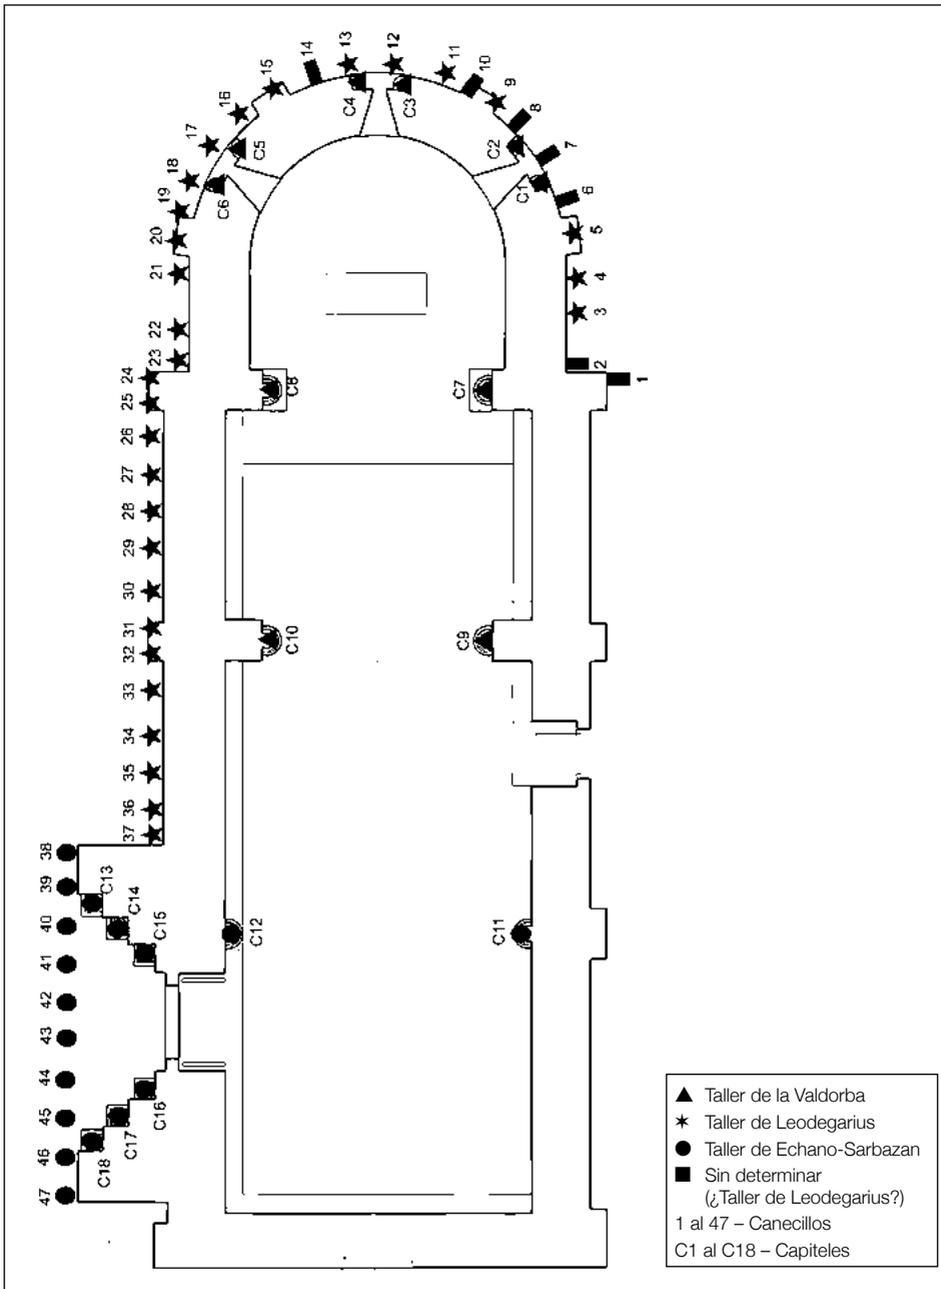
Planta de San Pedro ad Vincula de Echano con indicación de los talleres que trabajaron en canecillos y capiteles. Planta: M. Á. Alfaro Sada /© Fundación Santa María la Real.
